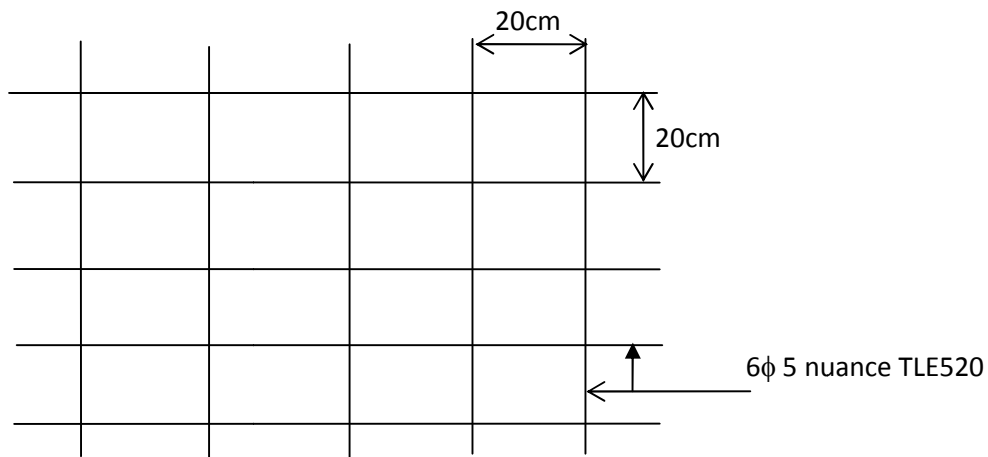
Ferrailage de la dalle de compression avec un treillis soudés (20×20)cm².
